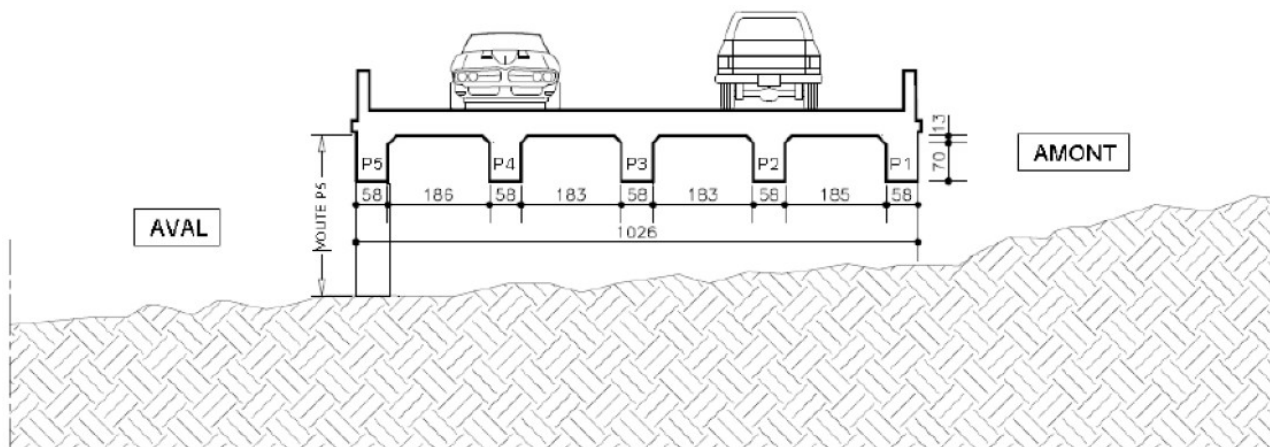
Profil en travers du pont Fontaine Cretet (Source : EOP - SEGIC)
